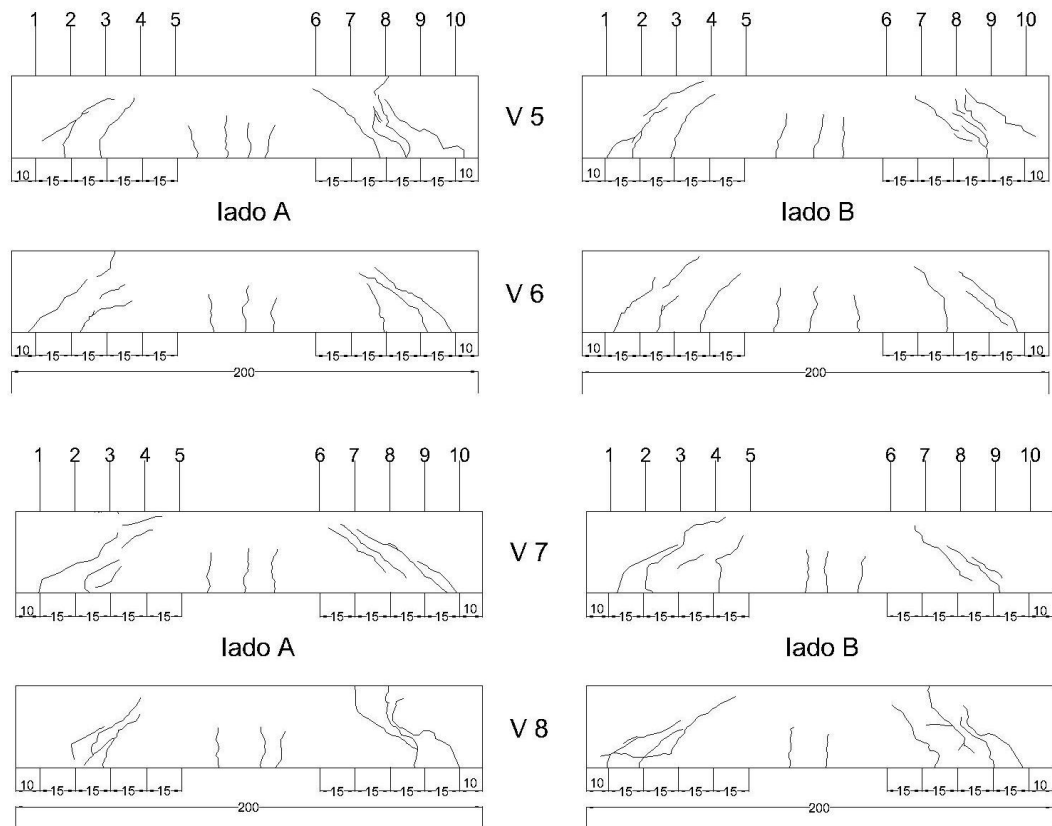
Patrón de agrietamiento por las 2 caras en vigas sin rehabilitar.
